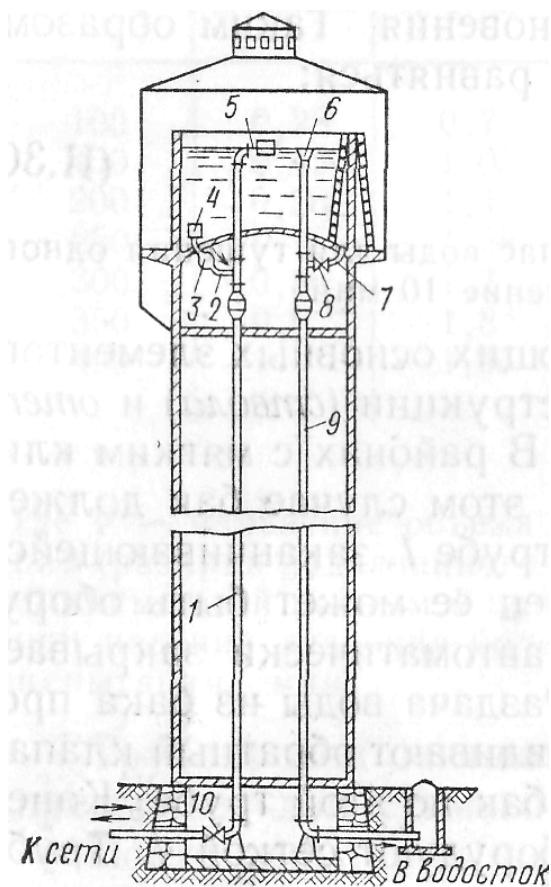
Схема оборудования водонапорной башни трубопроводами
